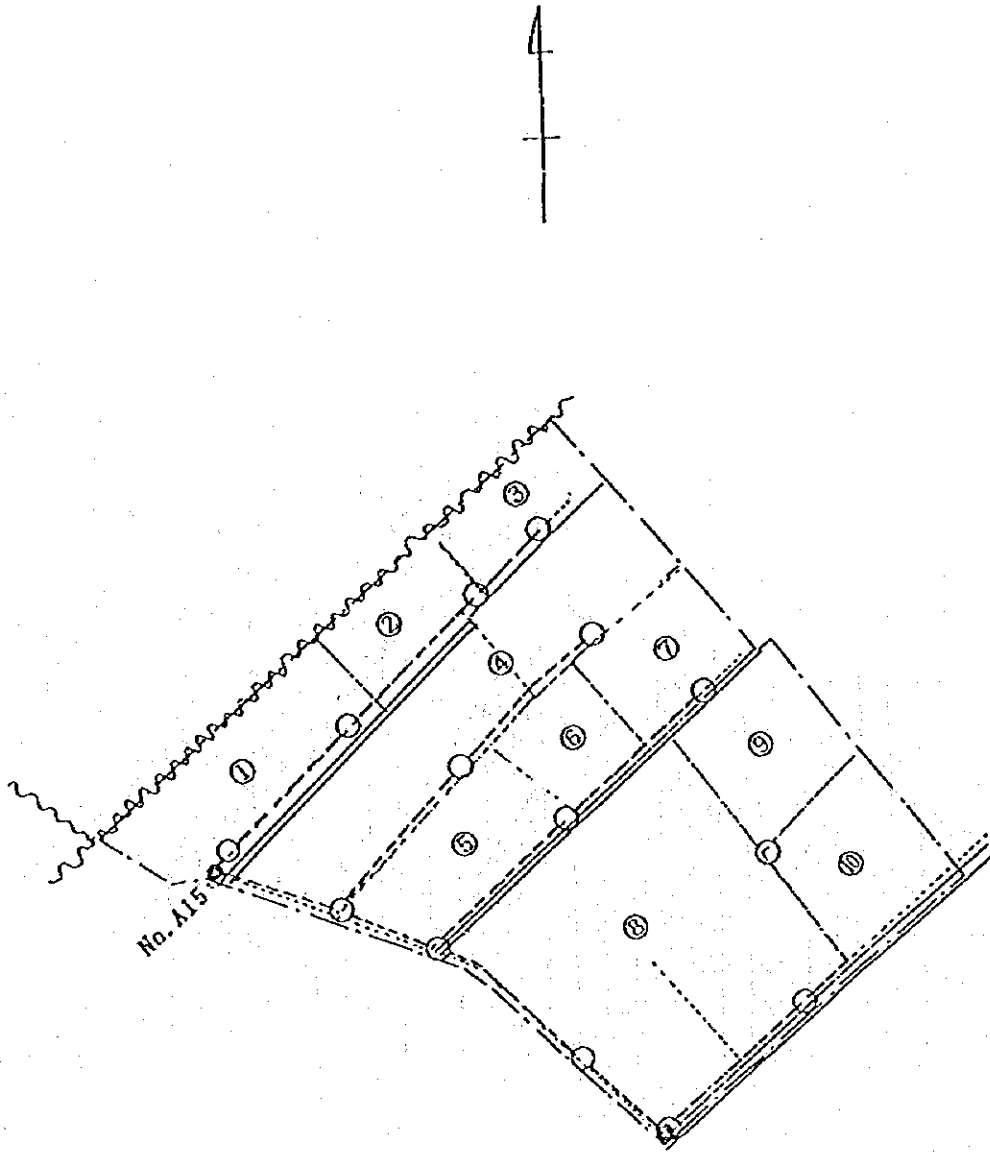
Plan horizontal du projet des installations terminales (Mansoura)
